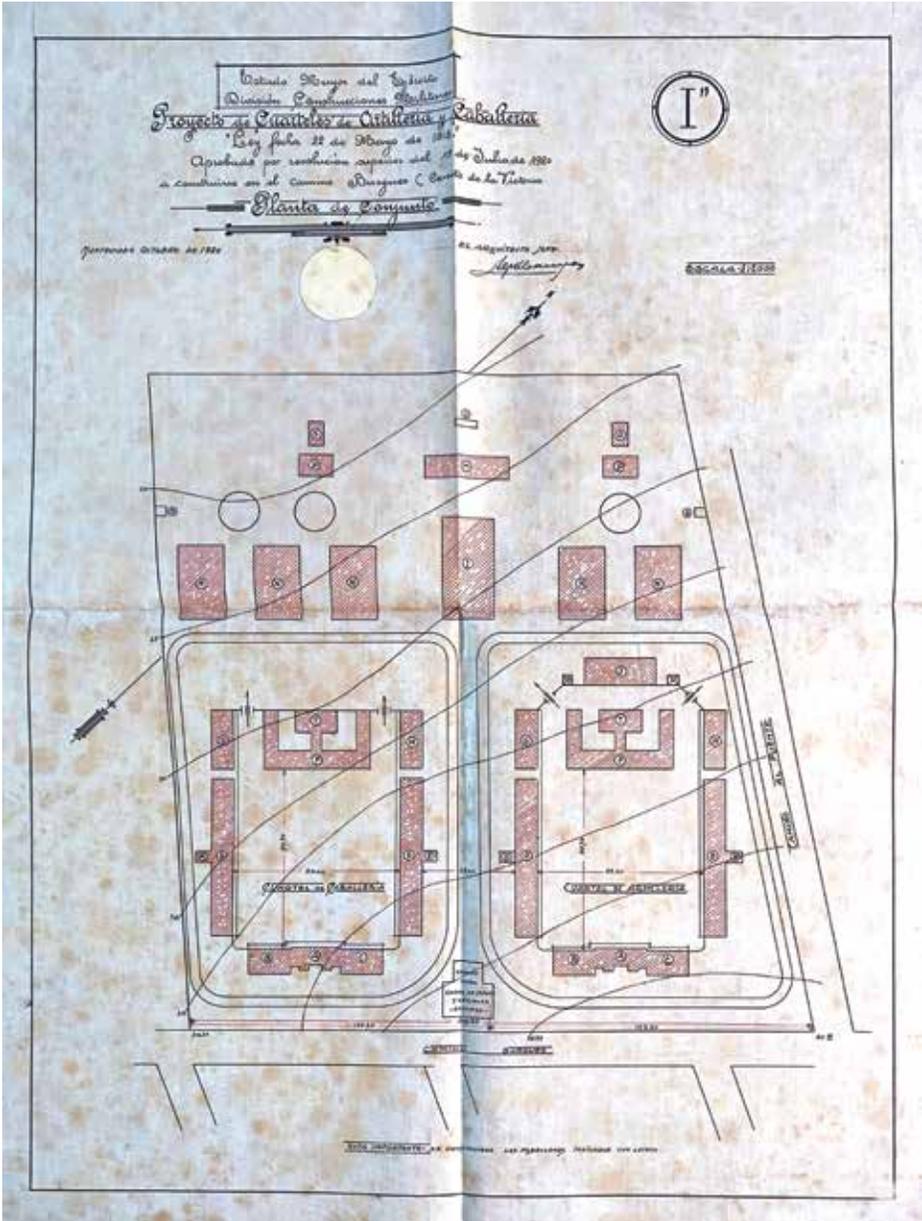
PROYECTO DE CUARTELES DE ARTILLERÍA Y CABALLERÍA EN LA AVENIDA BURGUES (PLANO ORIGINAL DE DISPOSICIÓN GENERAL). DIVISIÓN DE CONSTRUCCIONES MILITARES, 1920. SOLAMENTE SE CONSTRUYÓ EL CUARTEL DE ARTILLERÍA.
